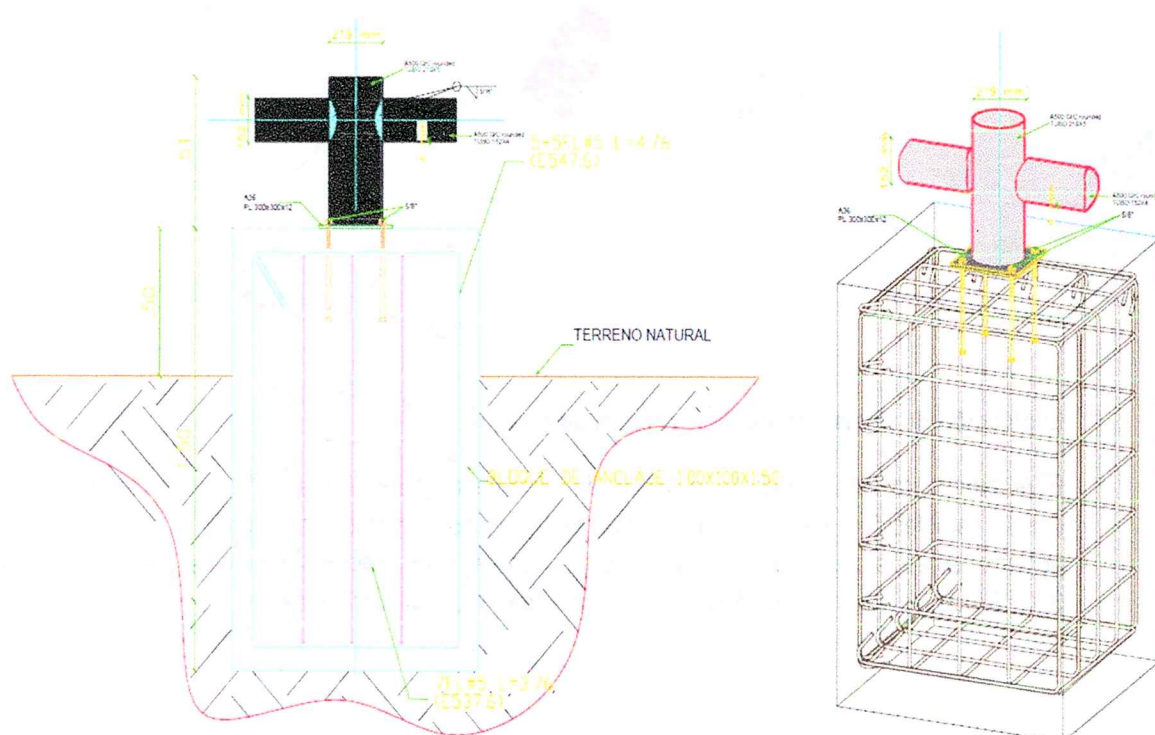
Detalle de distribución de refuerzos del macizo de anclaje.
